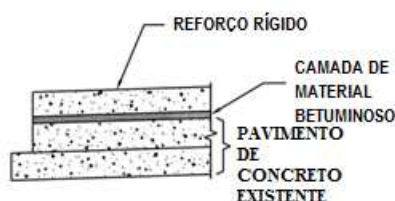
Camada de reforço rígido não aderente sobre o pavimento rígido (Adaptado - FAA, 2009a).
